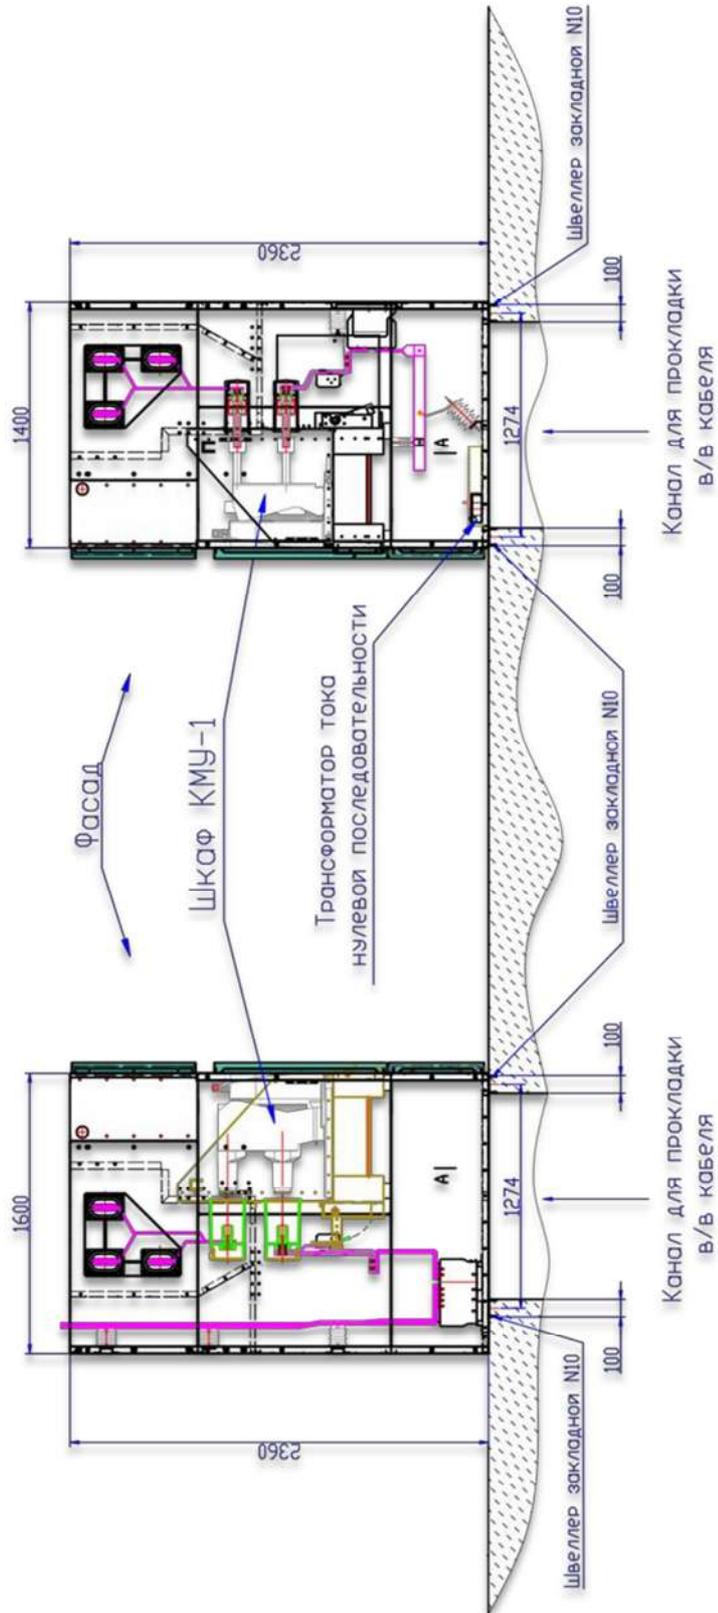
Установка на фундамент шкафа КМУ-1
